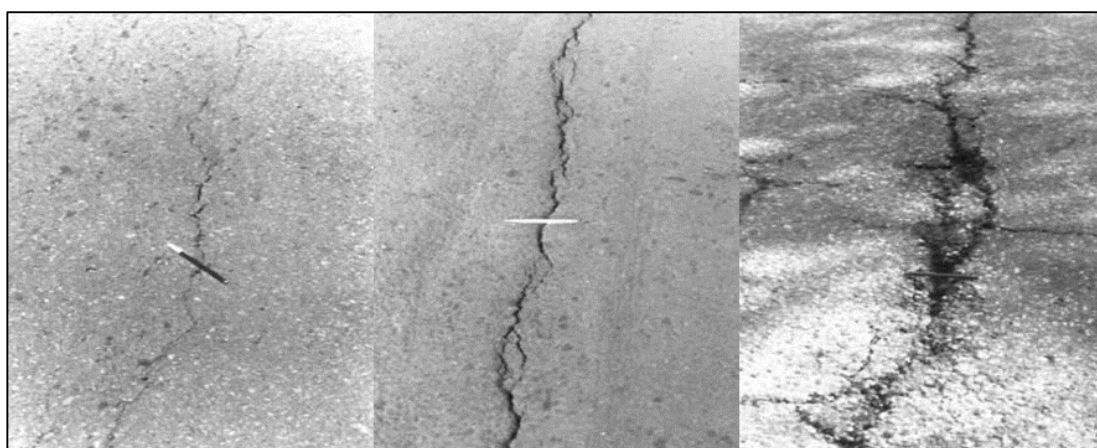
Grietas longitudinales y transversales de baja, media y alta severidad.
